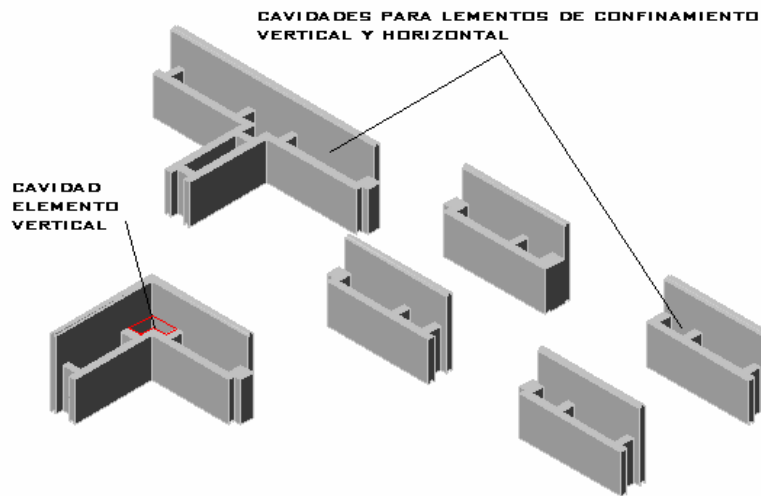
CAVIDADES ELEMENTO DE CONCRETO PARA ALOJAR LOS ELEMENTOS DE CONFINAMIENTO EMBEBIDO EN MÓDULOS Y LA LOSA O VIGA DE DIAFRAGMA
